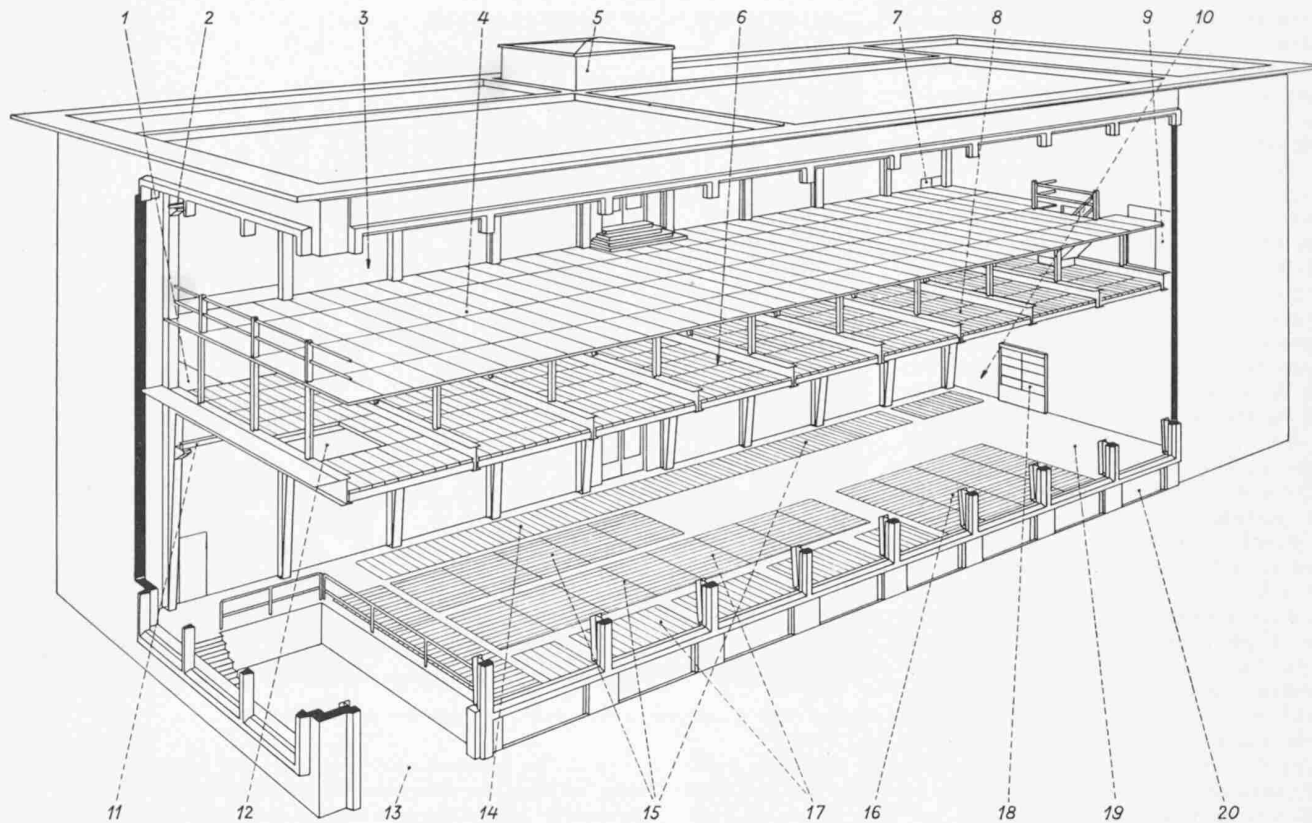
Coupe en perspective des halles d'essais inférieure et supérieure
